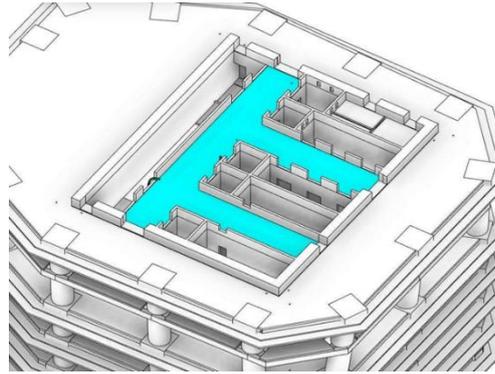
Dalle du noyau bétonnée grâce aux conduitex de la partie
